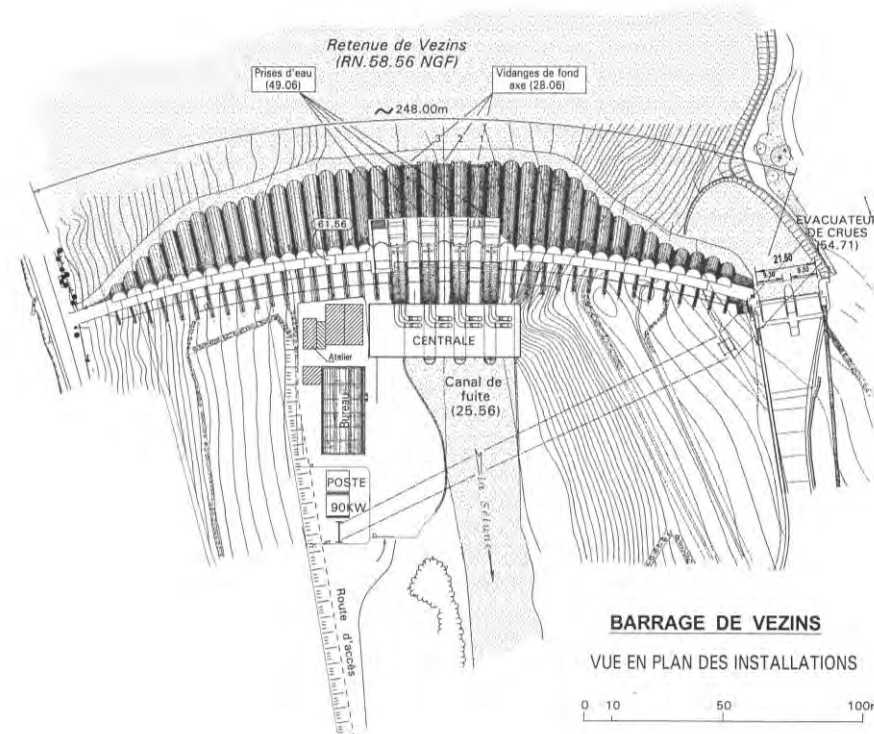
VUE EN PLAN DES INSTALLATIONS DES BARRAGES
